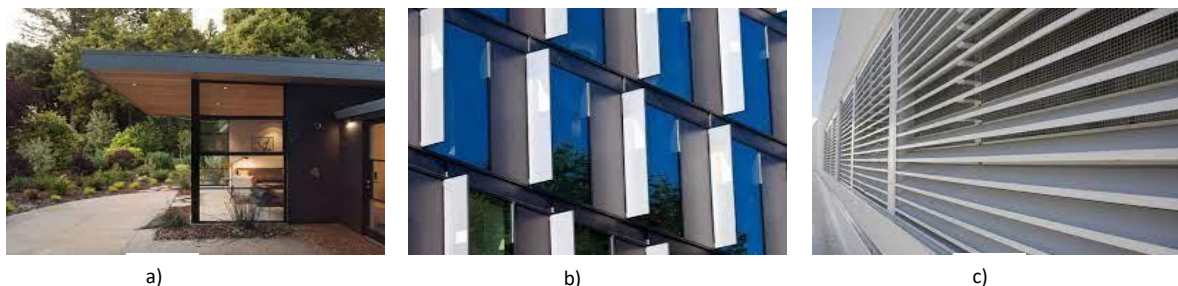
Dispositivos de proteção solar fixos. a) Palas horizontais, b) Palas verticais, c) *Louvres* (Persiana) (Fonte: a www.gardenista.com/posts/the-sheltering-sky-10-ideas-how-to-enhance-your-house-with-a-roof-overhang/ | b) www.indiamart.com/proddetail/aluminium-fins-20311589591.html | c) bossaluminium.com/louvers.html
